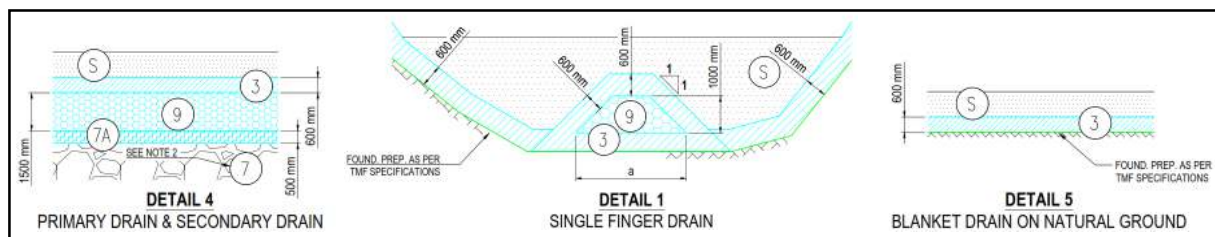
1: Detalles típicos del sistema de drenaje inferior (1824-363-CI-DRG-T0054)
